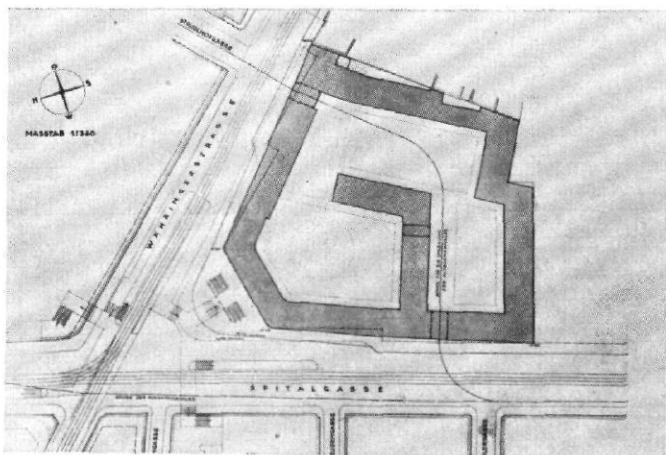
/ Wettbewerb Wien / Architekt: Josef Frank / Lageplan 1:3000
